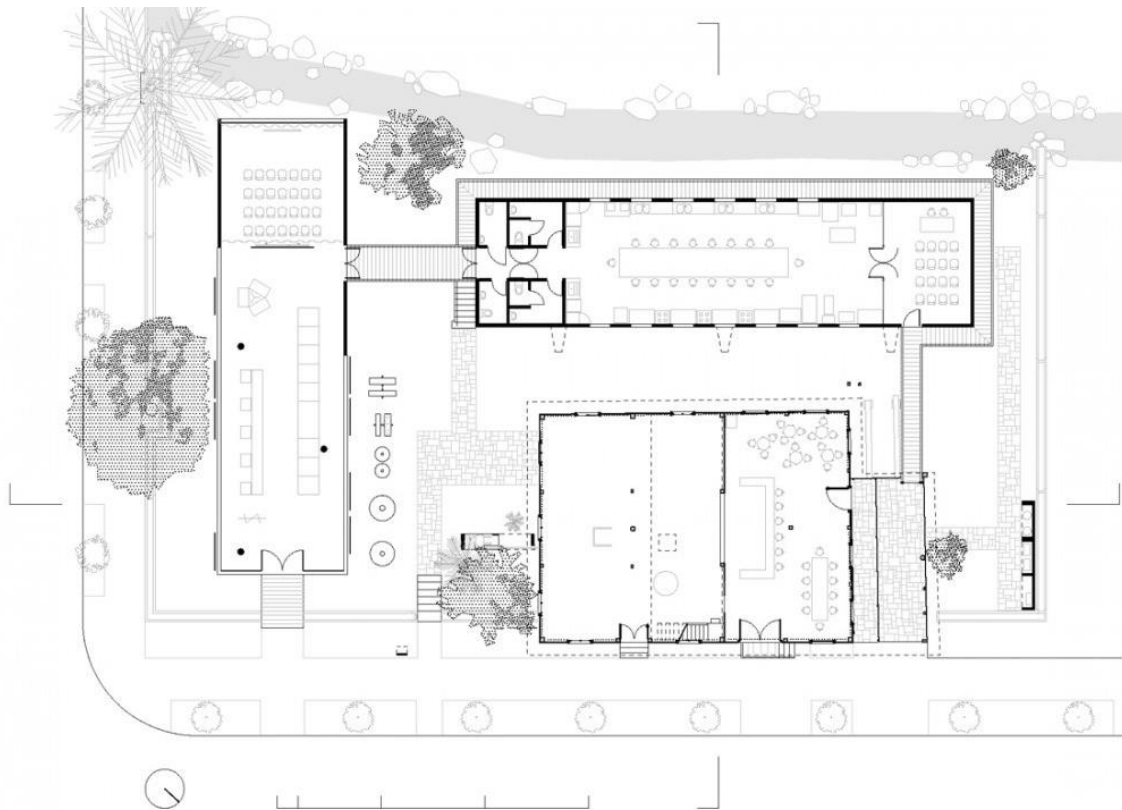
Planta arquitectónica, © Brasil Arquitectura
